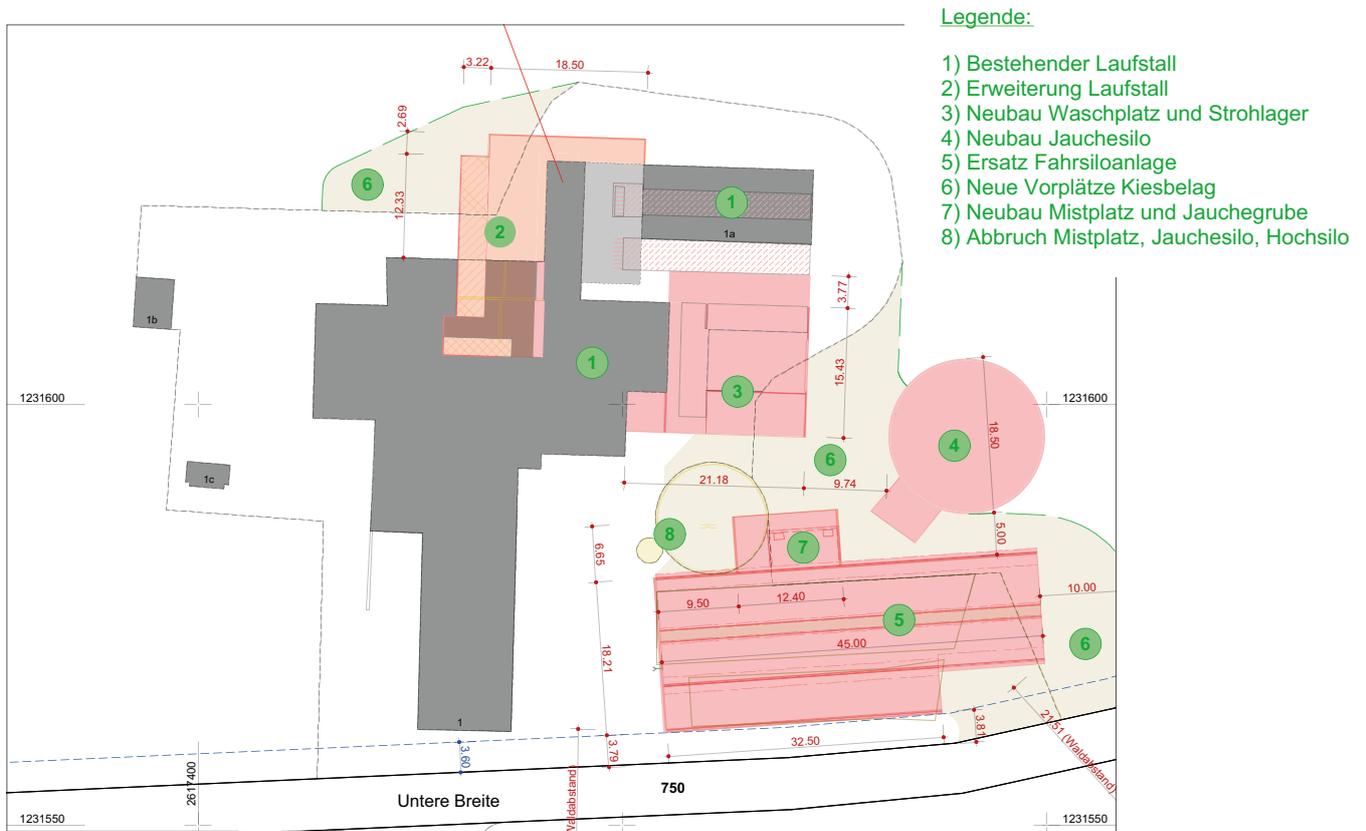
Situationsplan Bauvorhaben mit geplanten Um- und Neubauten in rosa (Quelle: Agroplanungen CH)
